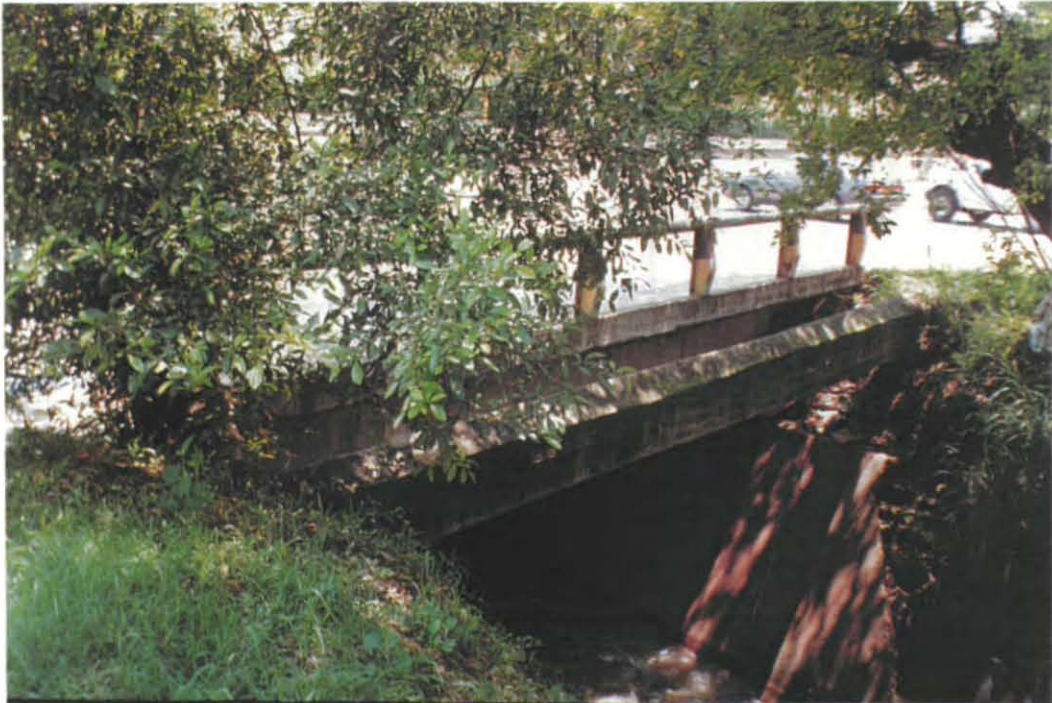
INS P - F27 VISTA LATERAL PUENTE VEHICULAR CALLE 9 CARRERA 50
